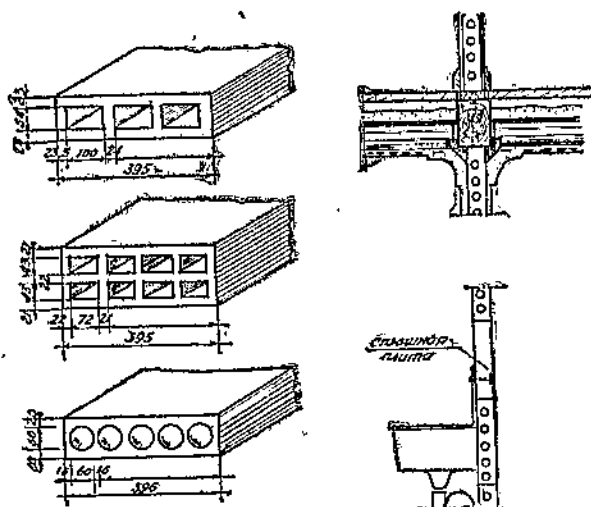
Гипсовые пустотелые плиты для перегородок, угольного или круглого сечения.
